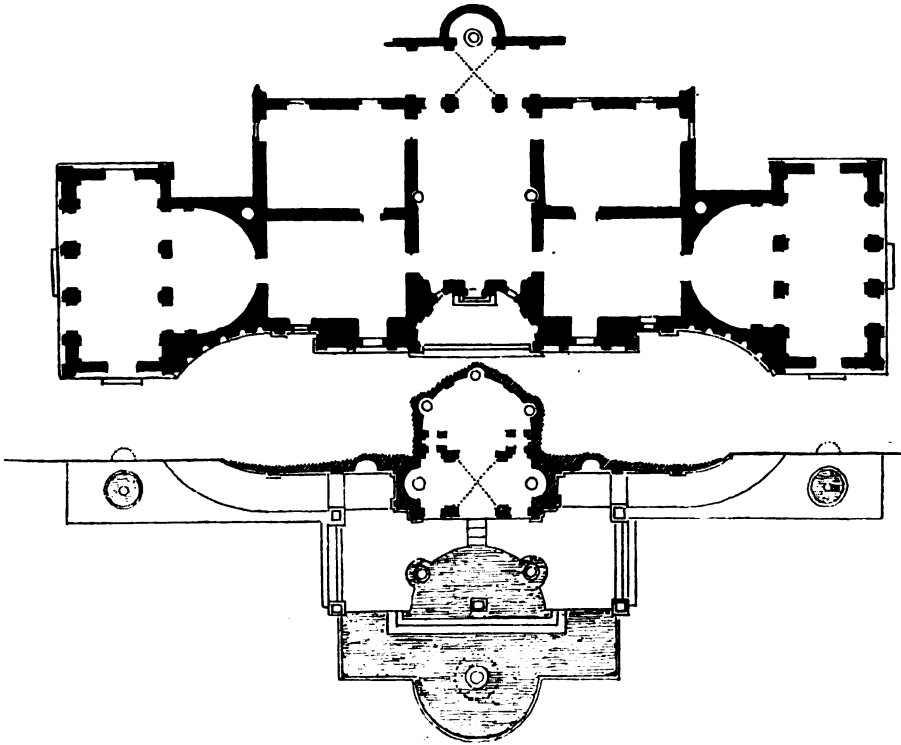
Villa Sacchetti. Grundriss (n. Percier und Fontaine).
